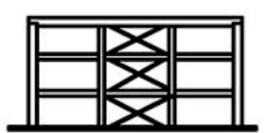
Refuerzo con diagonales. (fuente: Evaluación, reparación y rehabilitación de estructuras de concreto)
